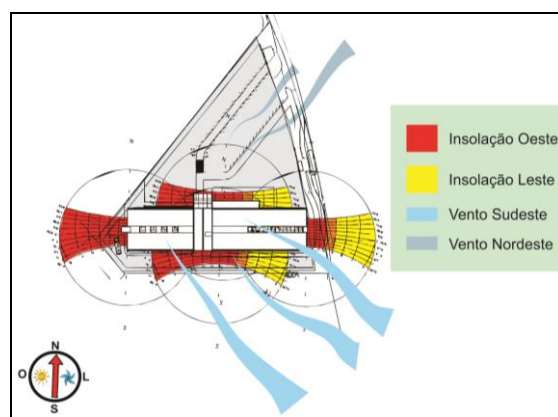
CETCON – Estudo de Insolação e Ventilação
